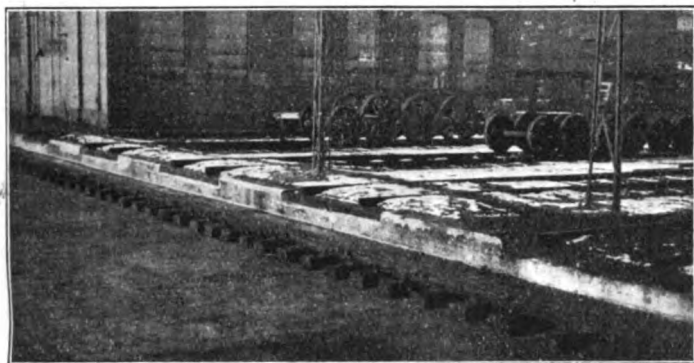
Laufschiene für Schiebebühnen auf Holzschwellen.
